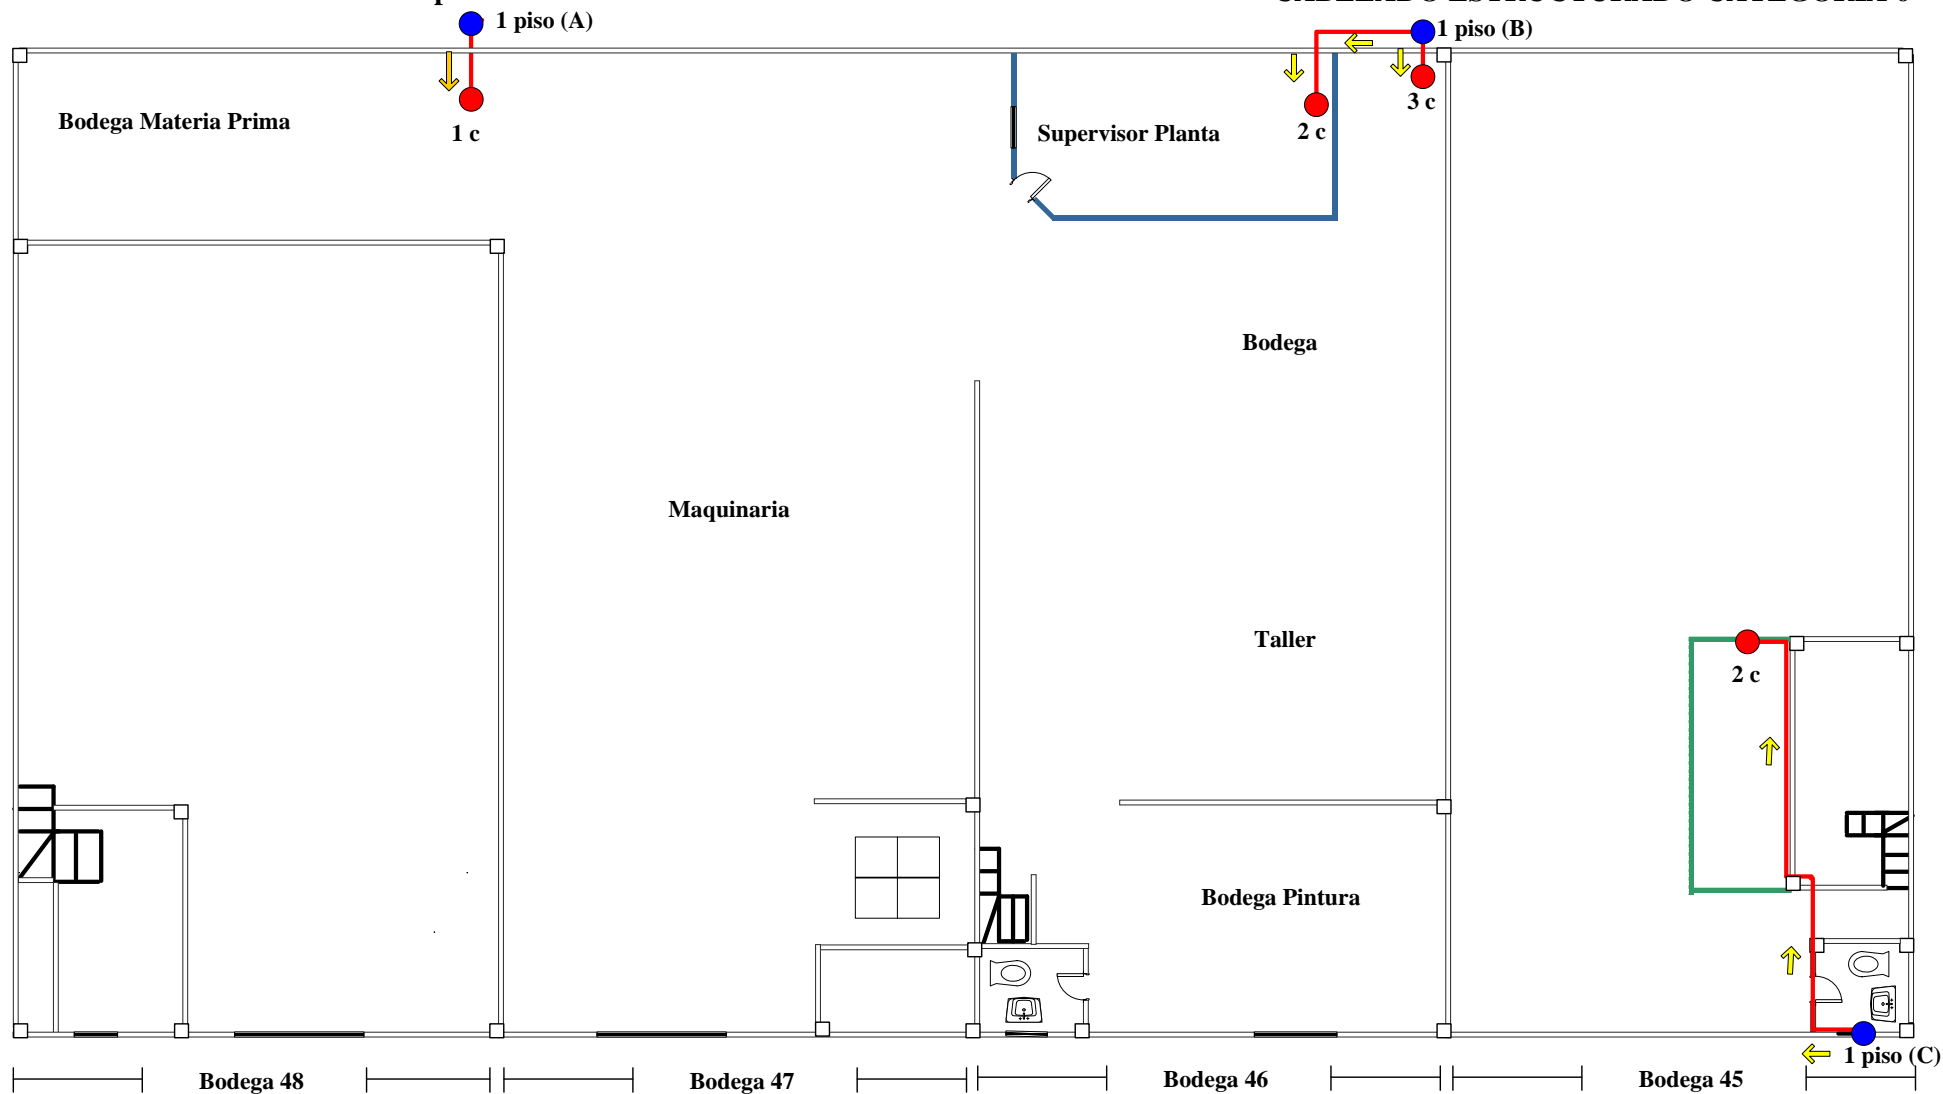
Diseño de rutas de tubería y cable UTP del Sistema de Cableado Estructurado Primer Piso
